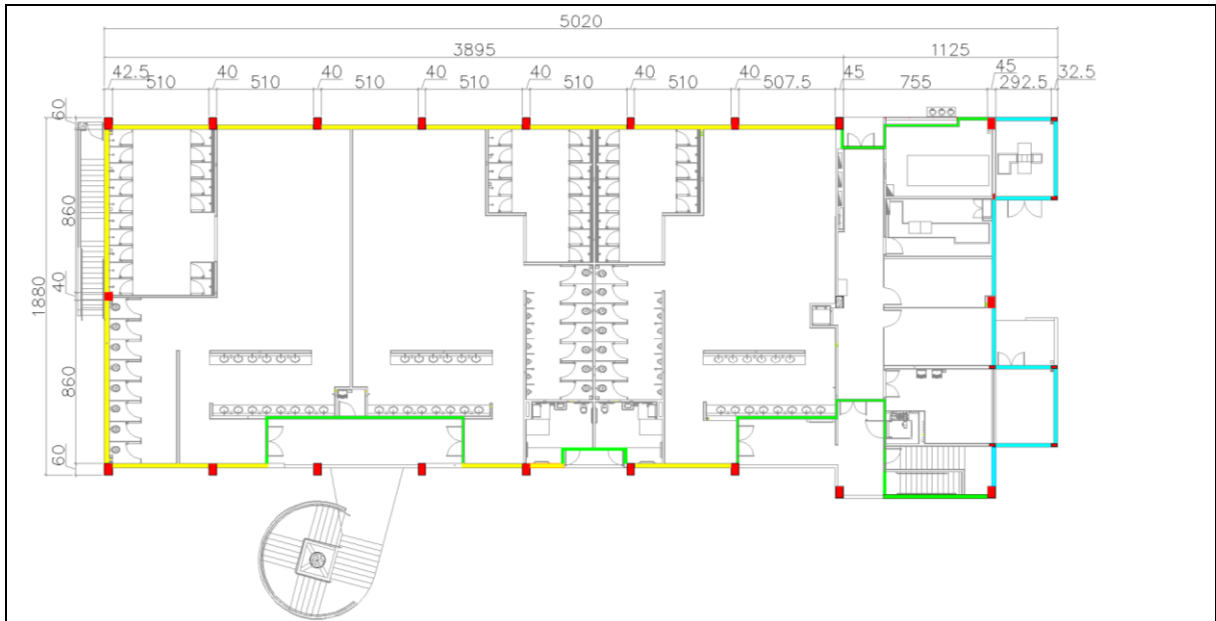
Planta Pavimento Térreo: identificação dos tipos de alvenarias
